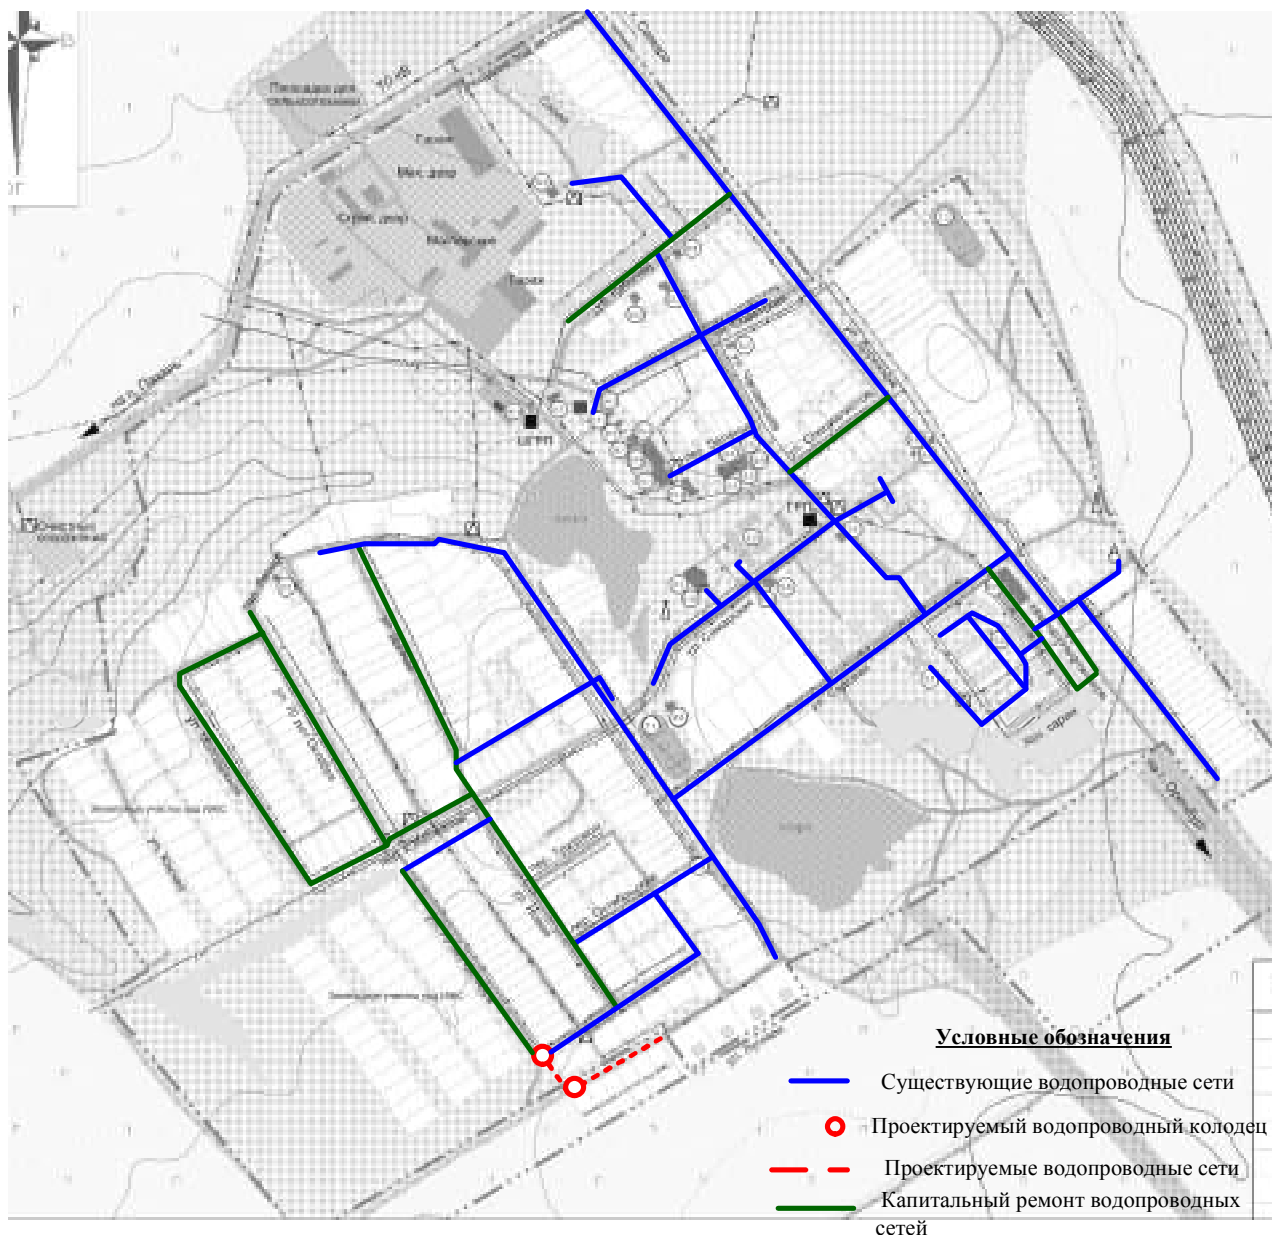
План водопроводных сетей п. Просвет на 2020 г.
